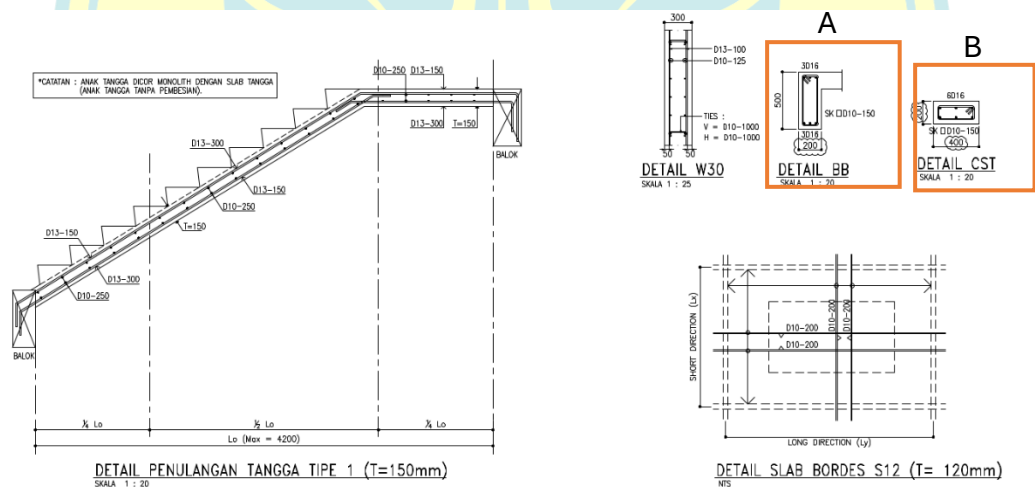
1 Surat *Engineer's Instruction* Perubahan Struktur Tangga
